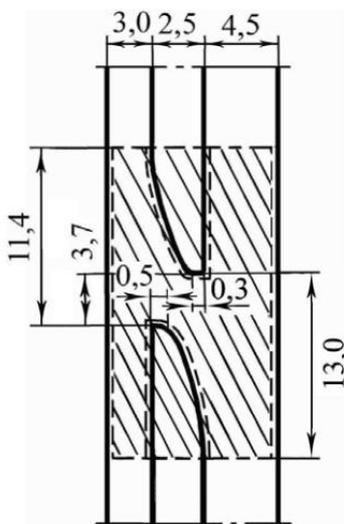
Типовое сопряжение горной выработки - перерубка
